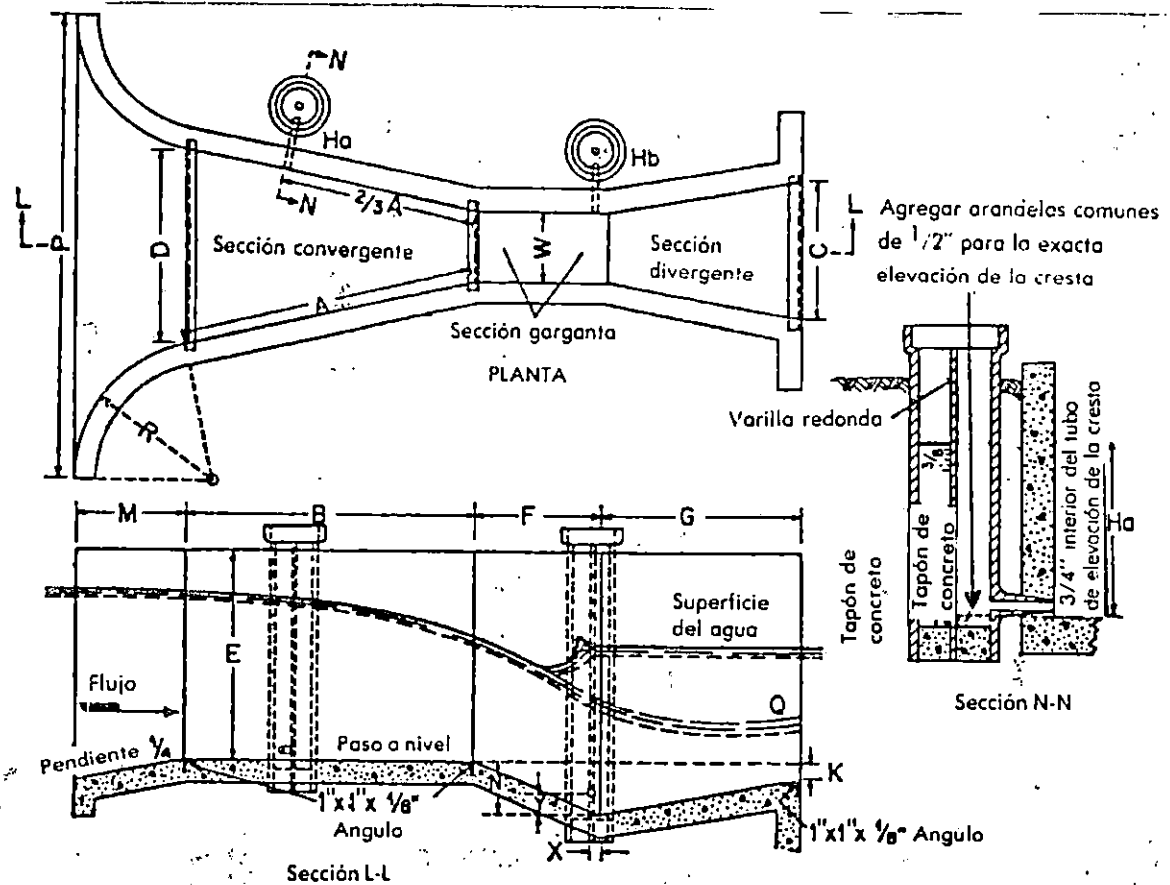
Planta, elevación y dimensiones del canal Parshall, (U. S. Soil Conservation Service [26]). Planta y elevación de un canal de medida Parshall de hormigón dando en letras las siguientes dimensiones; W = tamaño del canal en plg. o pie; A = longitud de las paredes laterales de la sección convergente; $(2/3) A$ = distancia posterior del extremo de la cresta al punto de medida; B = longitud axial de la sección convergente; C = ancho del extremo aguas abajo del canal; D = ancho del extremo aguas arriba del canal; E = profundidad del canal; F = longitud de la garganta; G = longitud de la sección divergente; K = diferencia en elevación entre el extremo inferior del canal y la cresta; M = longitud del piso de la entrada; N = profundidad de la depresión en la garganta de bajo de la cresta; P = ancho entre los extremos de las paredes curvas de entrada; R = radio de las paredes curvas de entrada; X = distancia horizontal desde el punto bajo en la garganta al punto de medida H_b ; Y = distancia vertical desde el punto bajo en la garganta al punto de medida H_b . (Ver tabla 5.14 las dimensiones para varios tamaños de canales)
